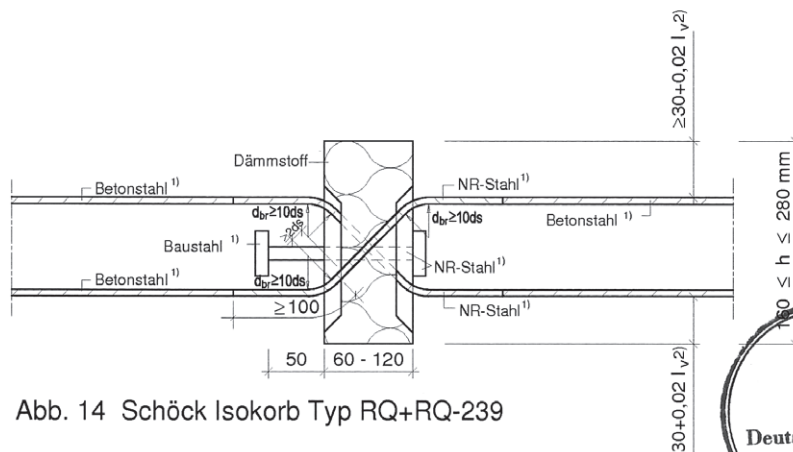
Schöck Isokorb Typ RQ+RQ-239
